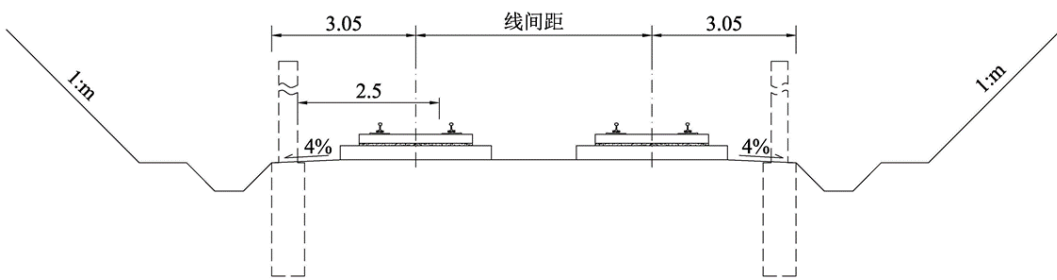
无砟轨道双线硬质岩路堑横断面示意图 (单位: m)
